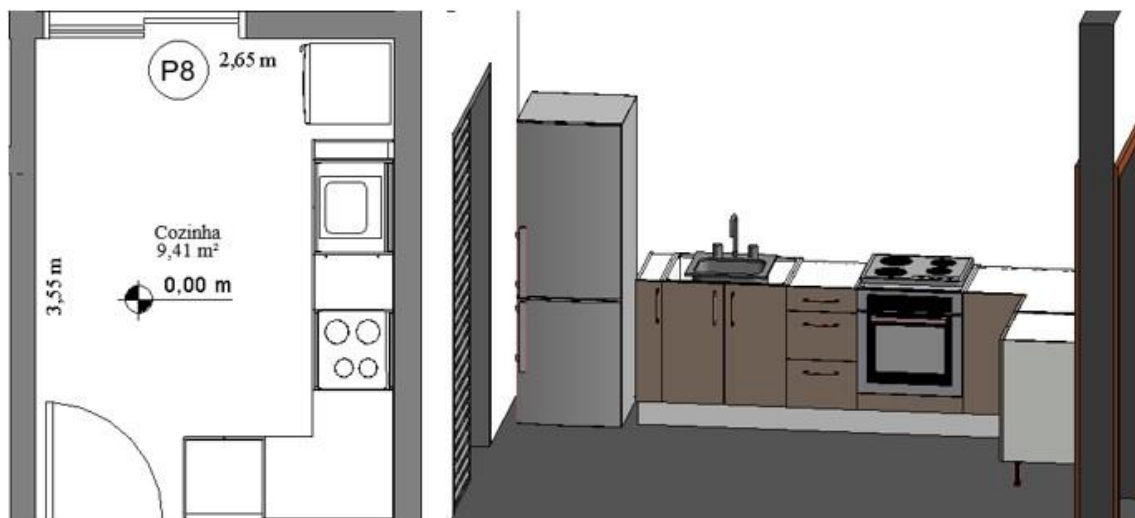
Vista em planta baixa e visualização 3D da cozinha (Fonte: própria autora)
